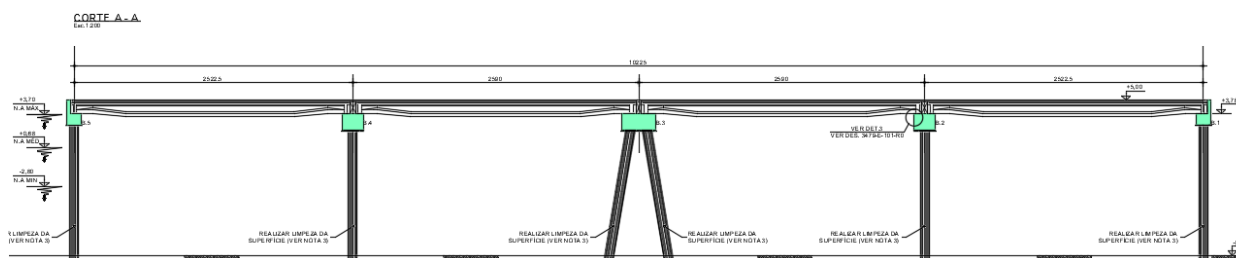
Elevação da OAE – Ponte de Acesso – Travessas com desprendimento do concreto.
